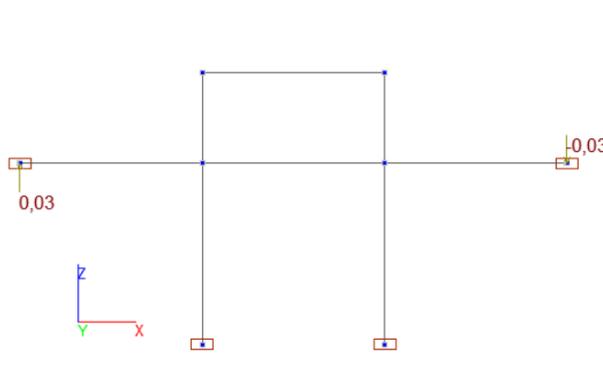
Нагрузка вида "заданное перемещение" на расчетной схеме
